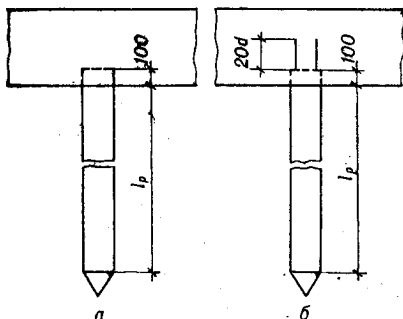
Конструкції з'єднання фундаменту з ростверком:
